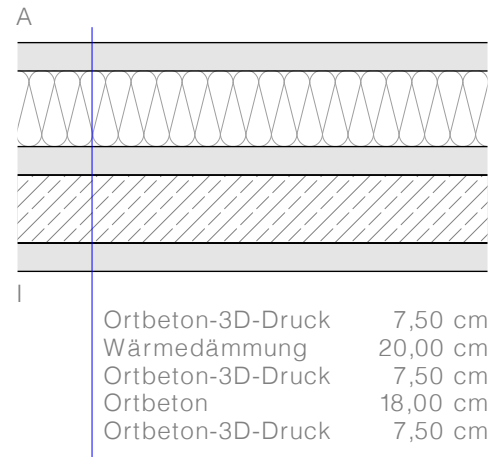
Bürogebäude Wandaufbau Außenwand | M 1.20
